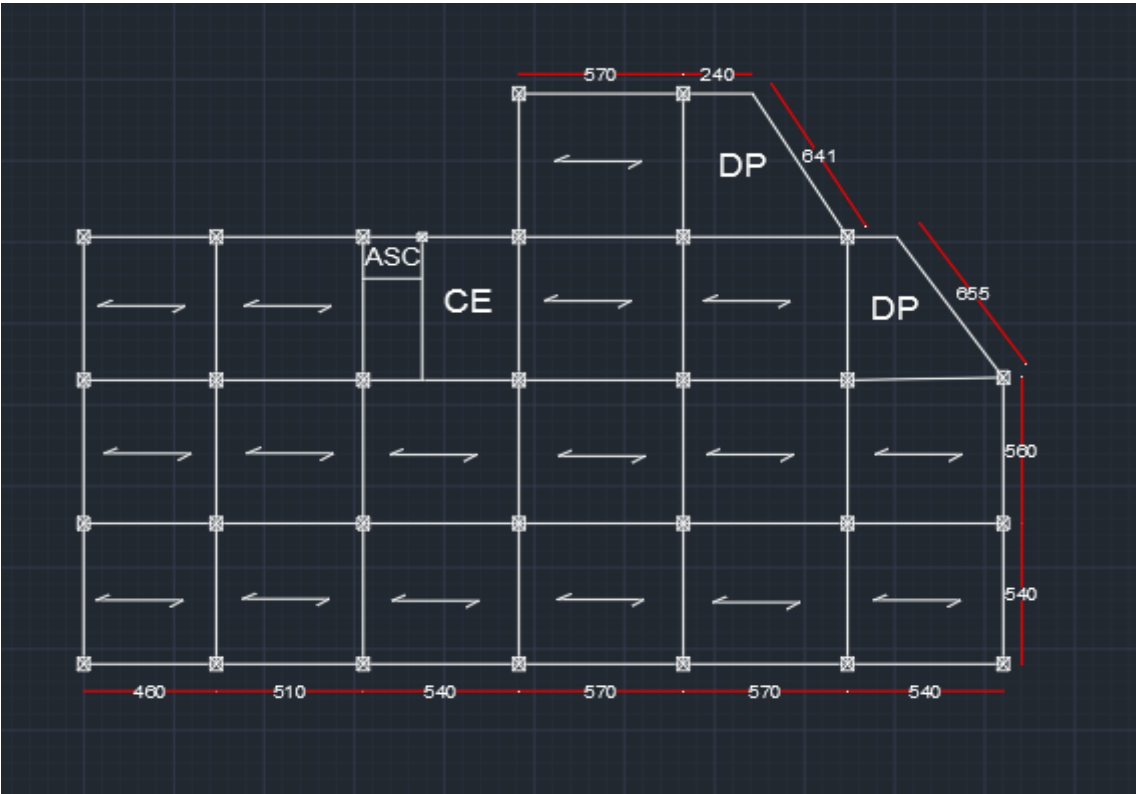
dispositions des poutrelles et positions des dalles pleines (autres étages).
